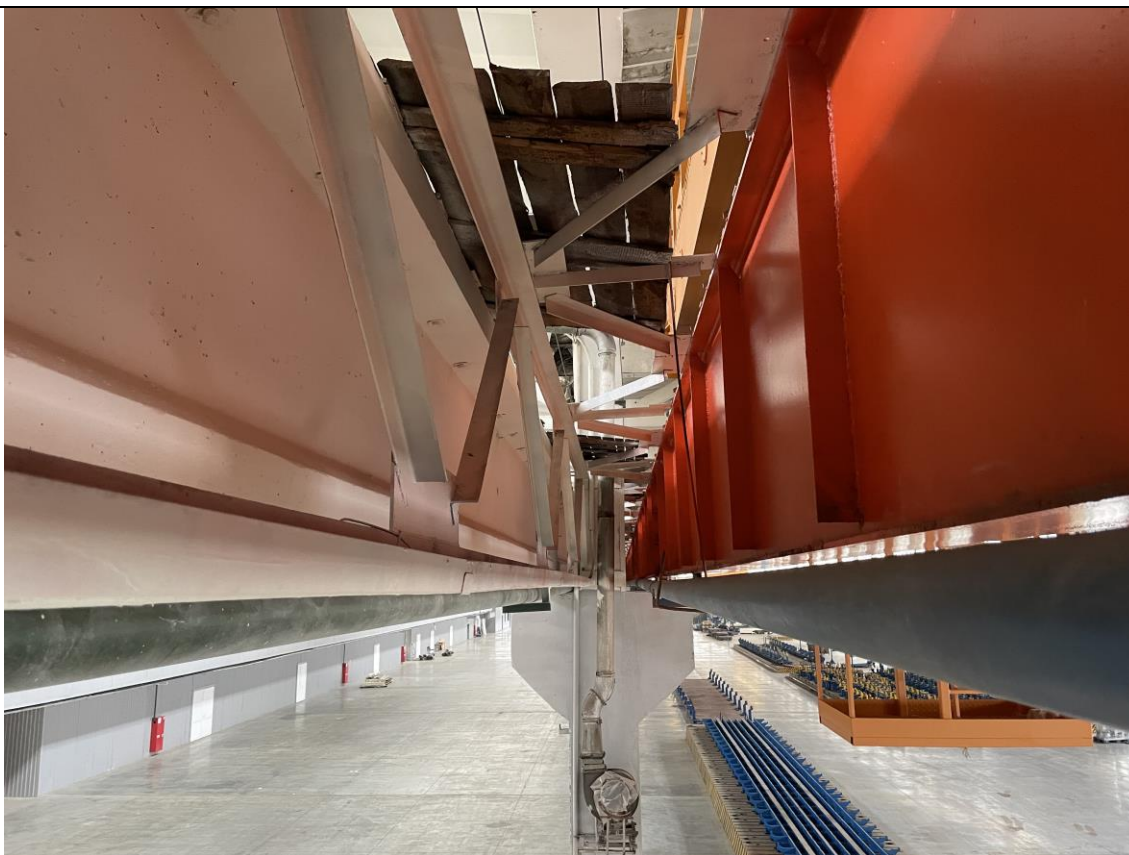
Подкрановые балки ПБ-2, ПБ-3. Крепление тормозной фермы к подкрановой балке ПБ-2
